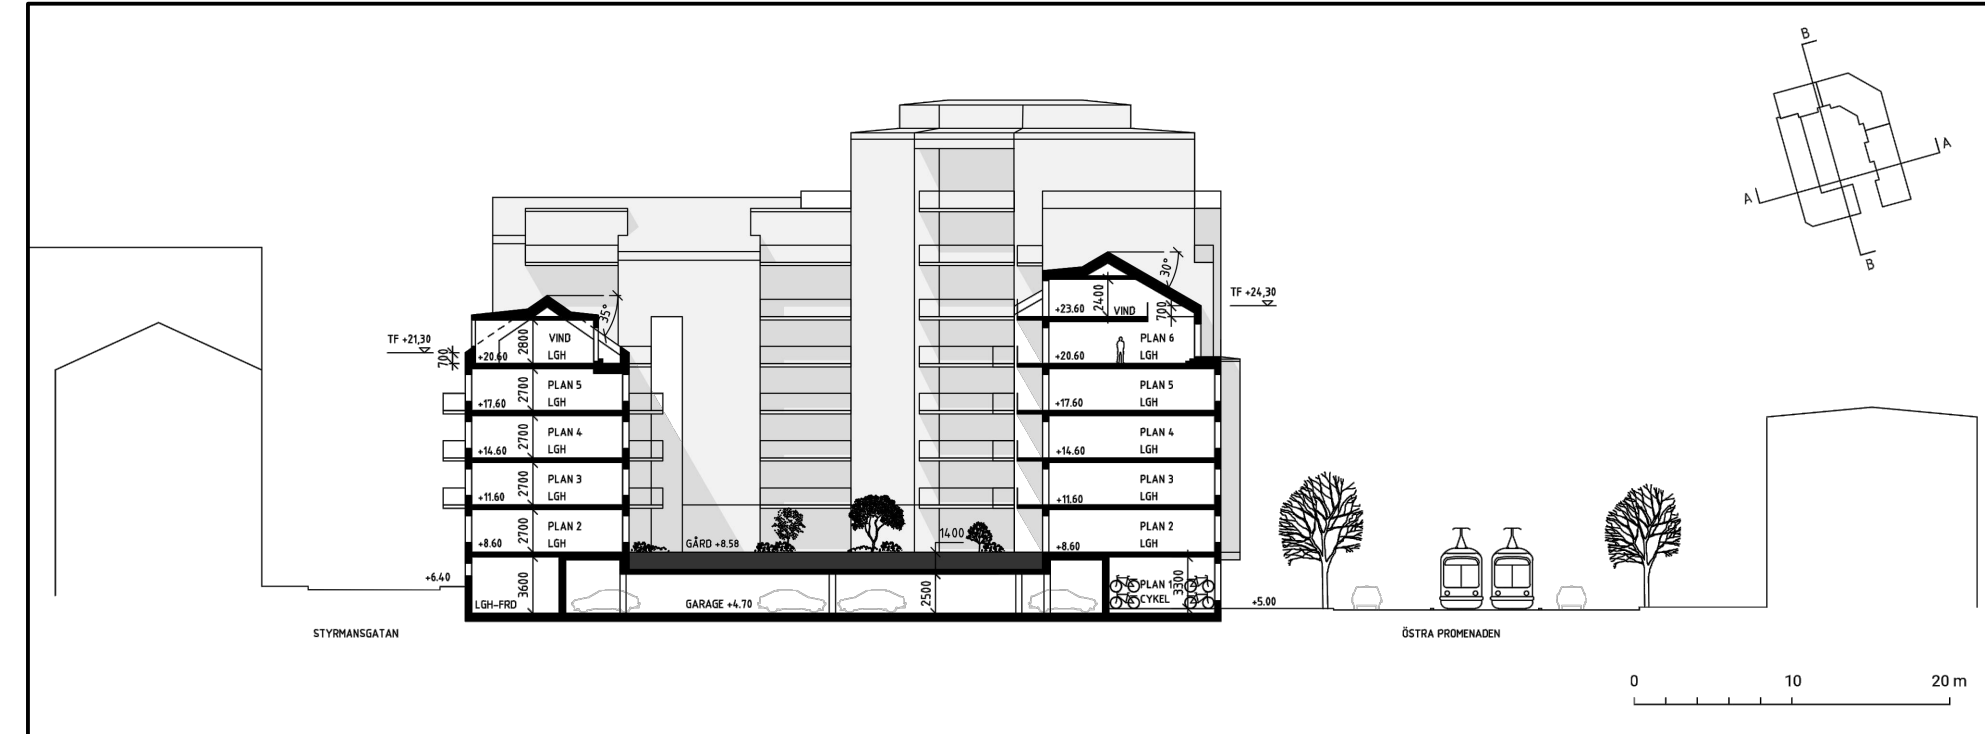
Sektion A-A som visar parkering delvis under mark med ett planterbart gårdsbjälklag över. I förslaget till detaljplan föreslås högsta marknivå till +8,8 meter över nollplanet vilket möjliggör för en innergård med planterbara ytor både för hantering av dagvatten och för att skapa en kvalitativ innergård för de boende. Illustration: Semrén & Månsson Arkitekter 2023.
